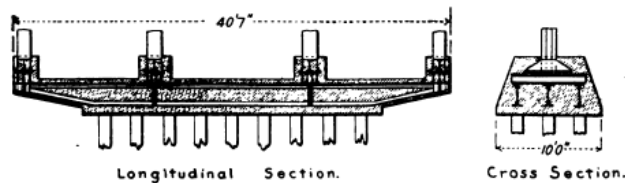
Cimentación mediante pilotes. Buel [3].
